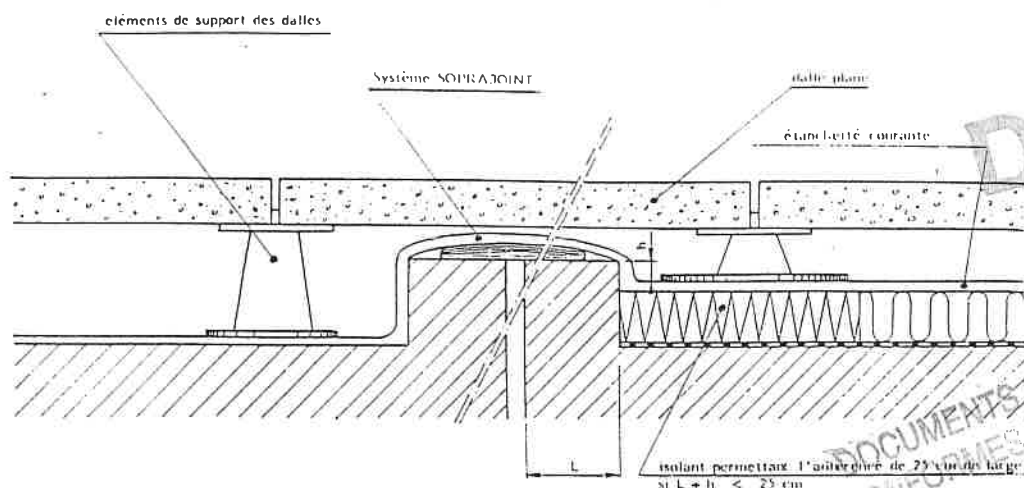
Protection des joints sur costières en toitures accessibles aux piétons et au séjour, protégées par dalles sur plots
